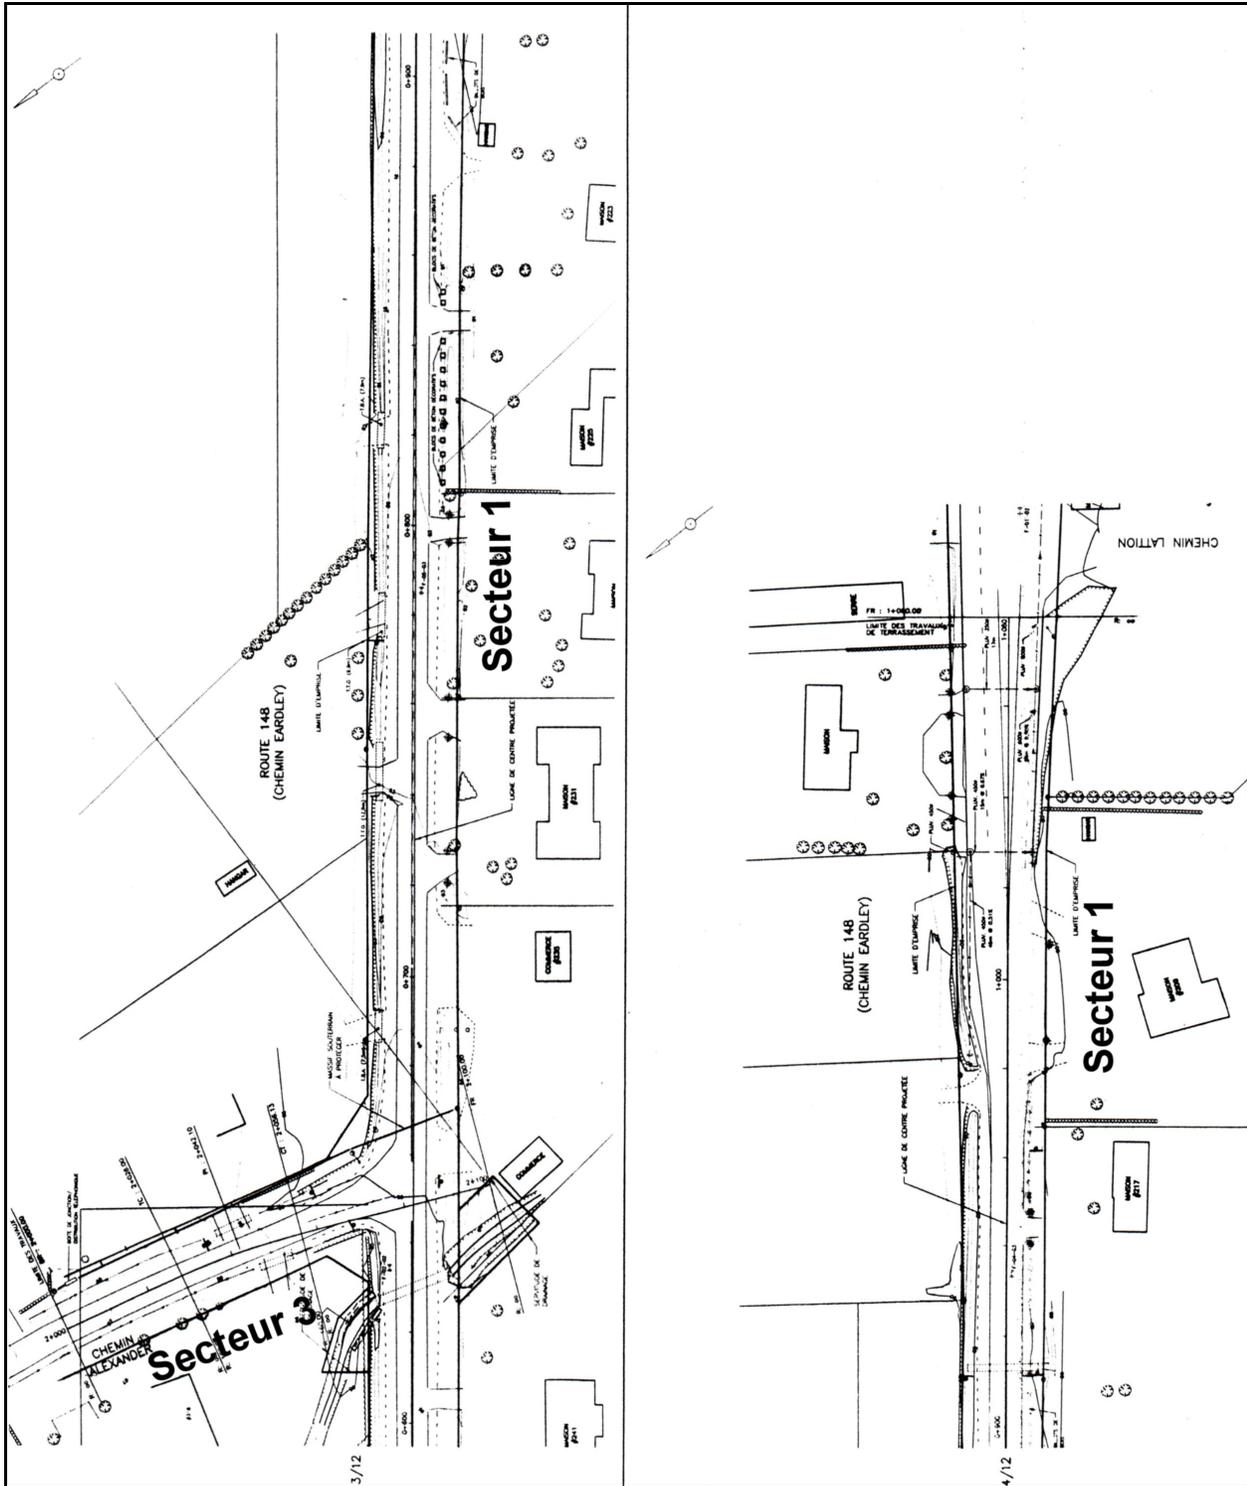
Localisation des secteurs d’inventaire sur le plan de construction du projet 20-6672-8479, route 148 (2/2)
